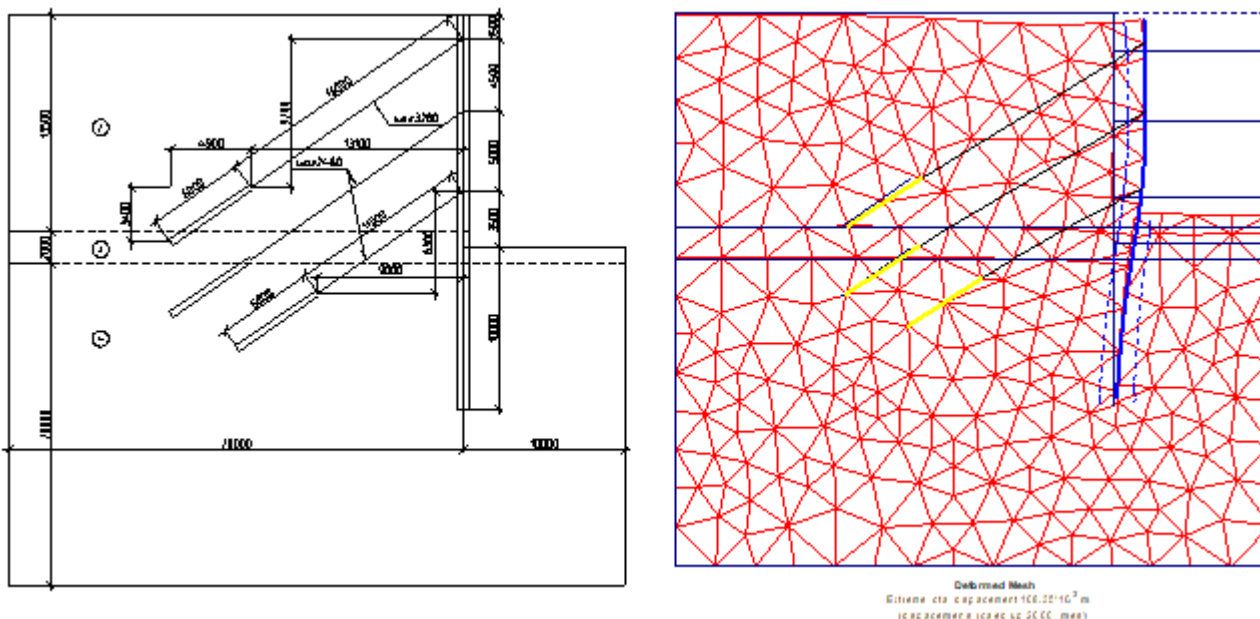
Расчетное сечение 2-2 Рисунок 7 – Деформированная схема расчетного сечения 2-2
